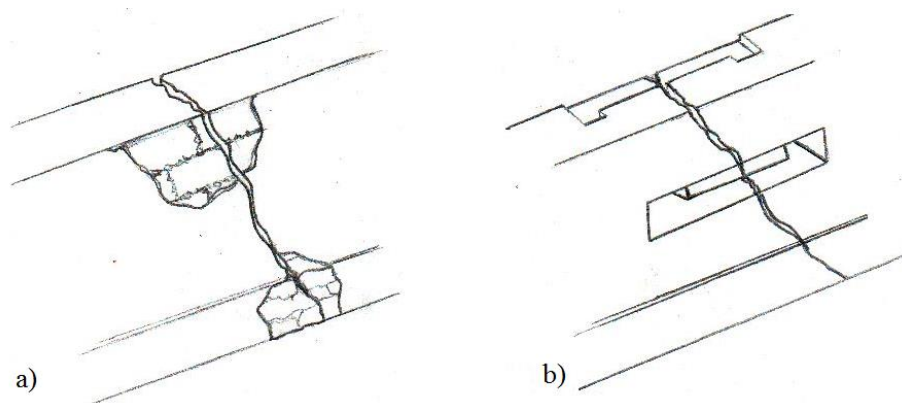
a) Fenda diagonal que atravessa o pano de bloco de adobe, b) Abertura em "U" pelo exterior e interior para reforço com alvenaria de tijolo lambaz, (Fonte: de autor)
